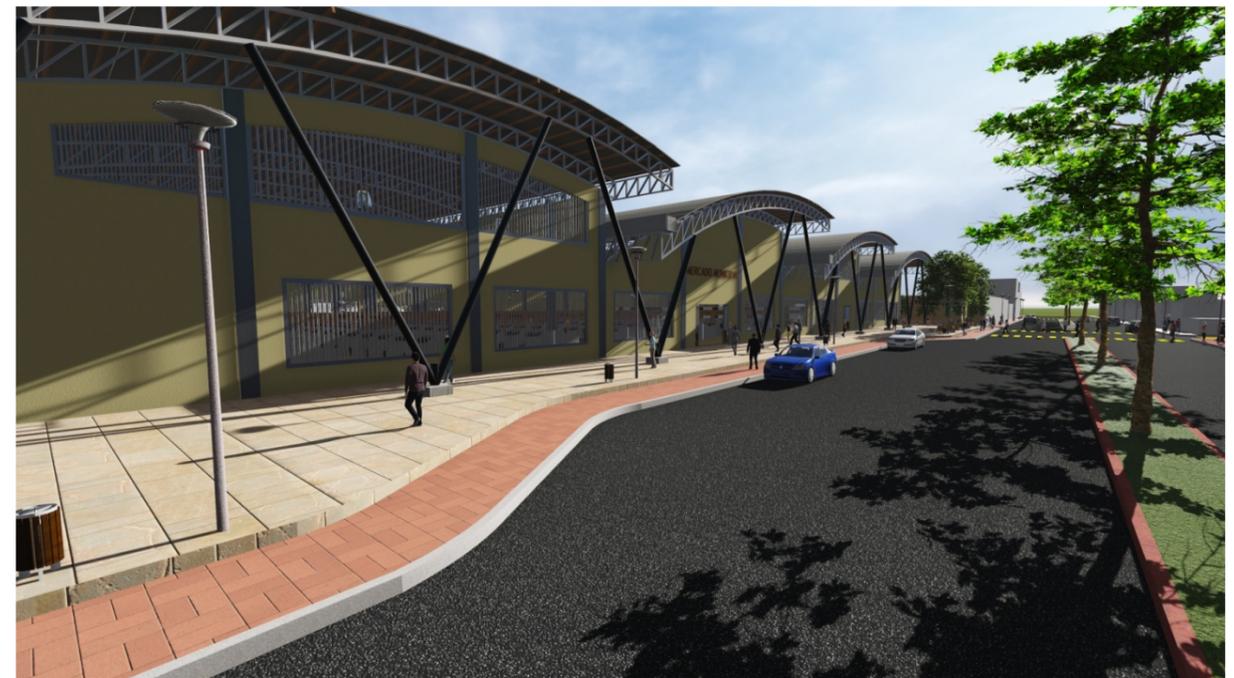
TRATAMIENTO DE FACHADAS CON REJAS METÁLICAS
